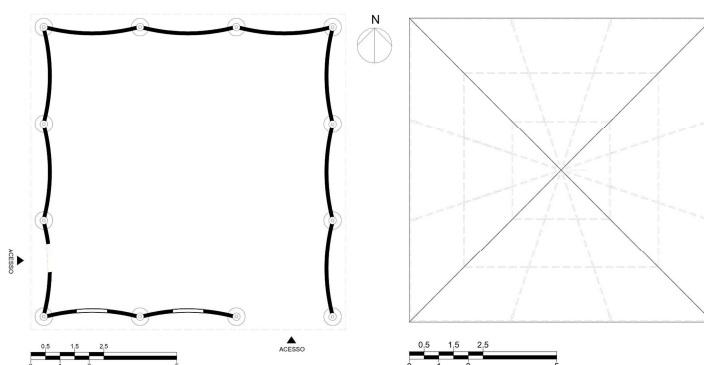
e 4 – Planta Térrea e planta Cobertura do barracão do terreiro Ilê Asé Oyá.
